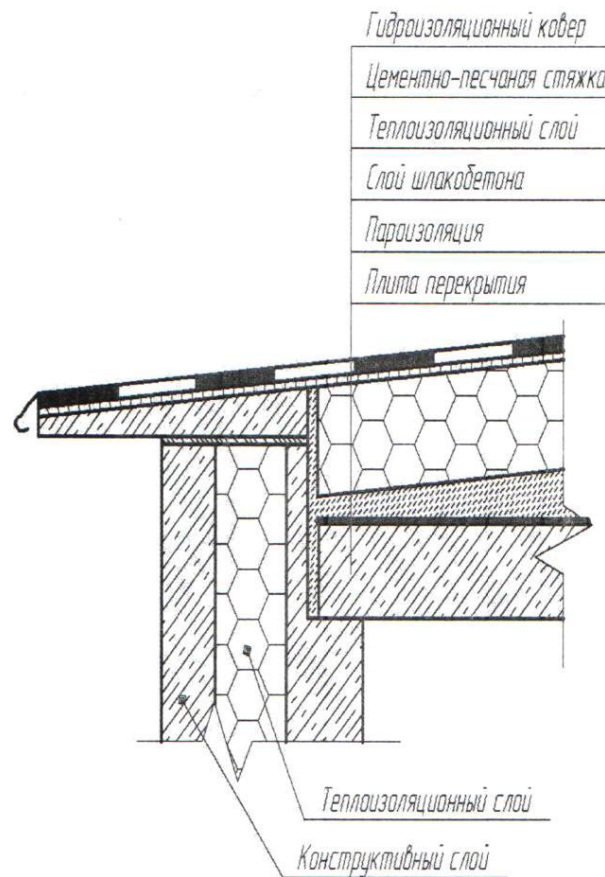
Конструктивна схема утеплення кровлі
